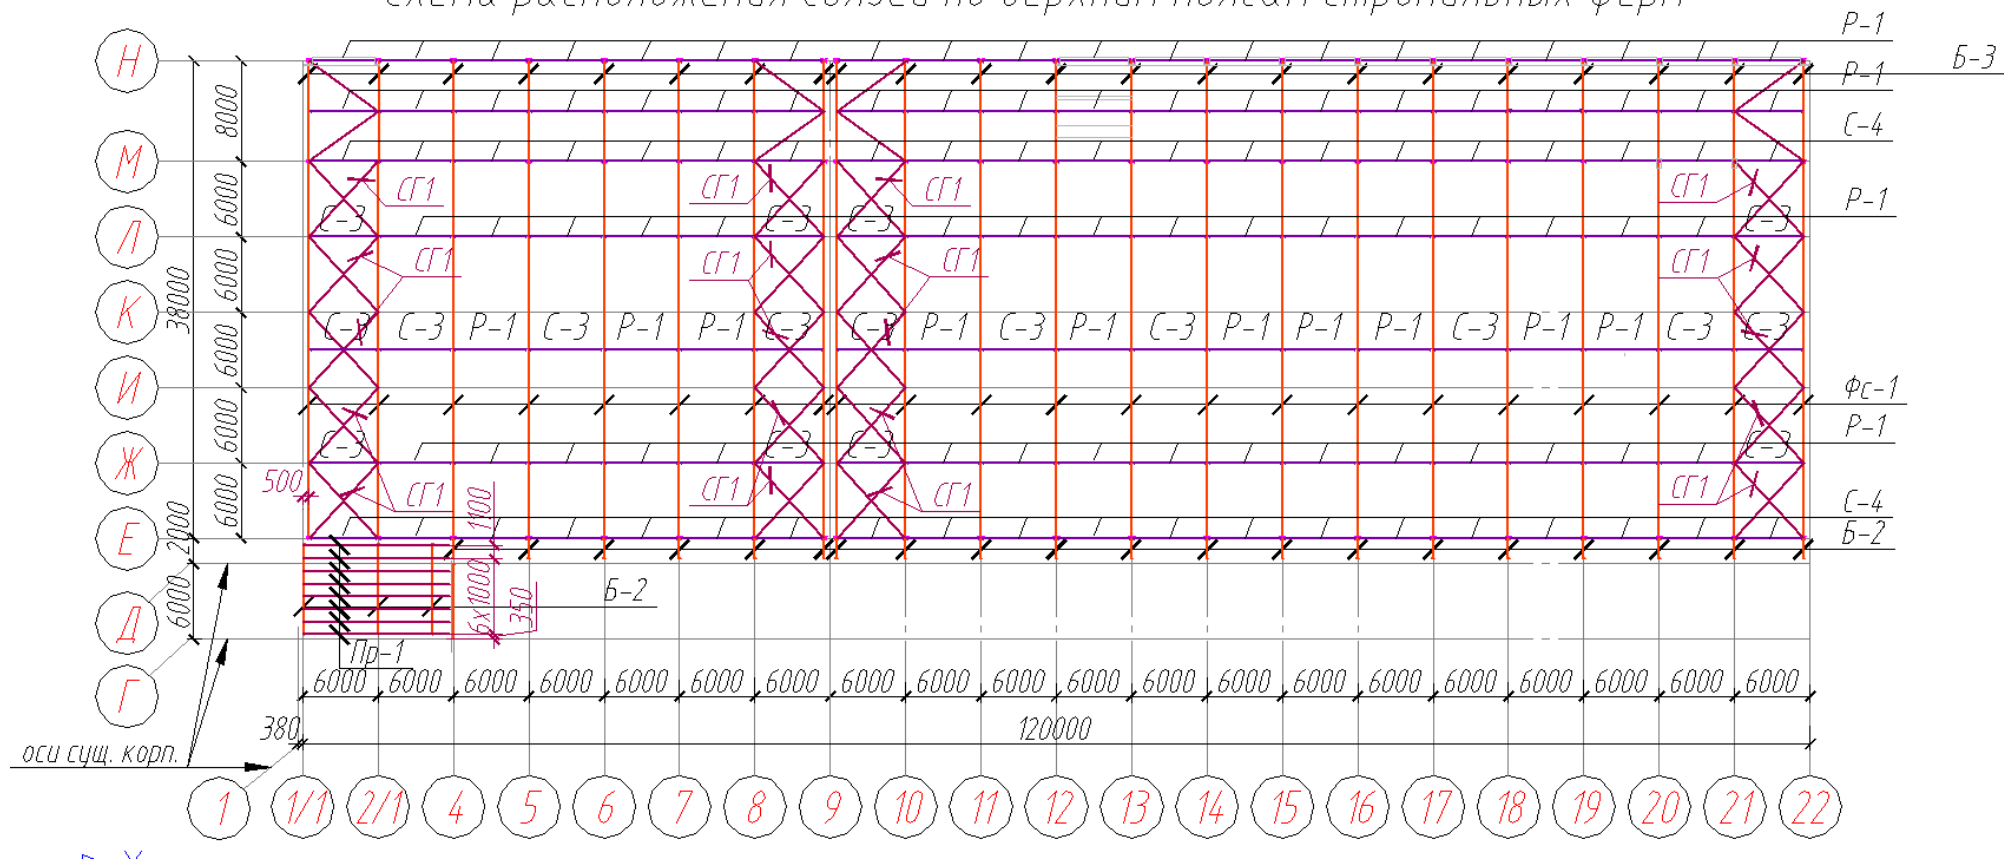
Схема расположения связей по нижним поясам стропильных ферм
